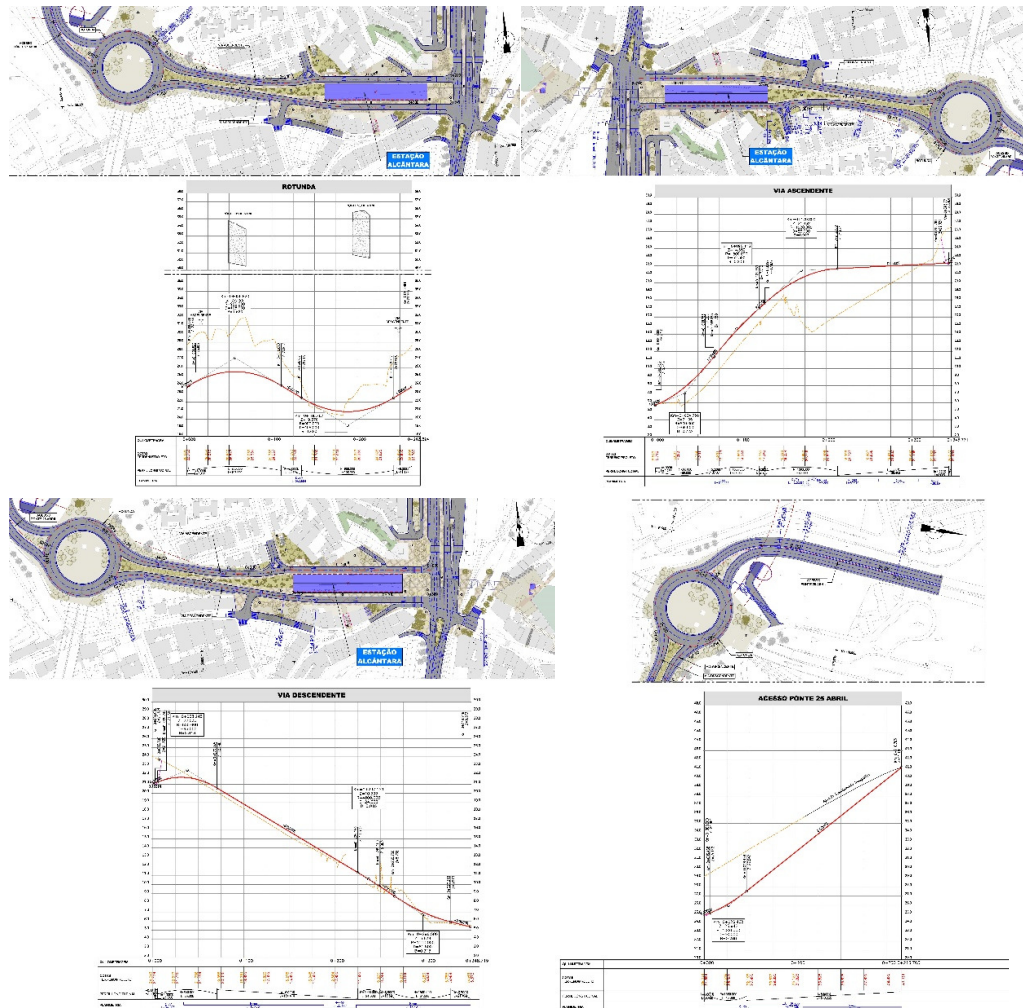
Estação de Alcântara - Plantas/Perfil Longitudinal das Rotunda, Via Ascendente e Via Descendente
